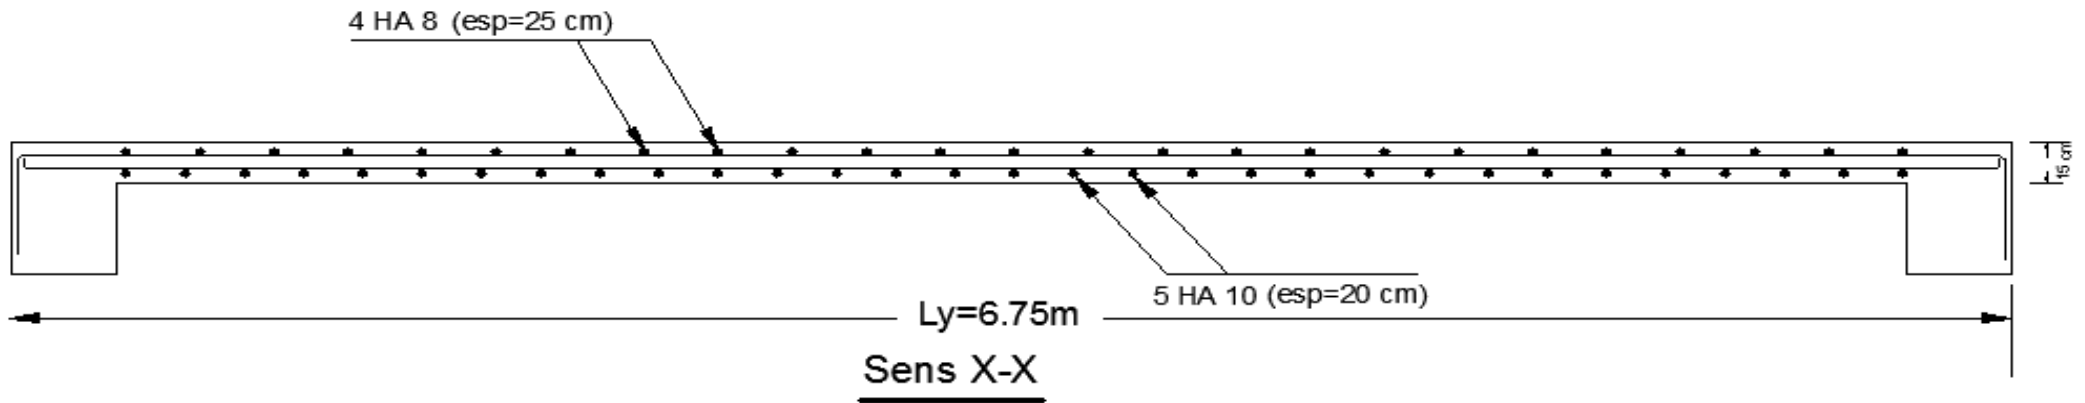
ferrailage de la salle machine sens (x-x)
